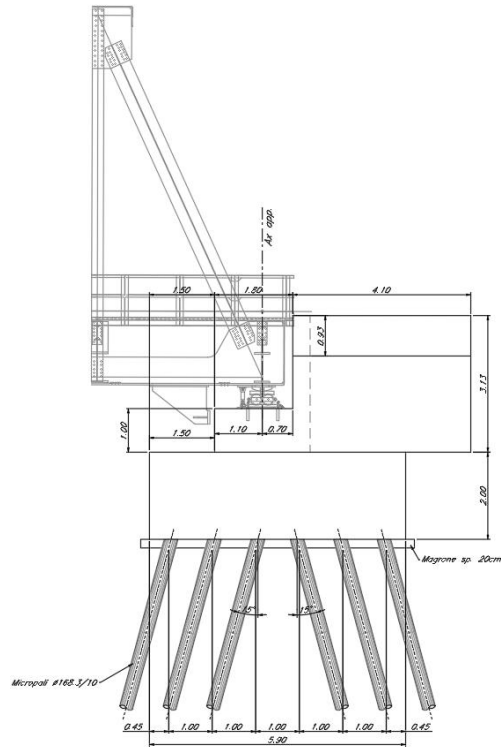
Prospetto Longitudinale Spalla B
